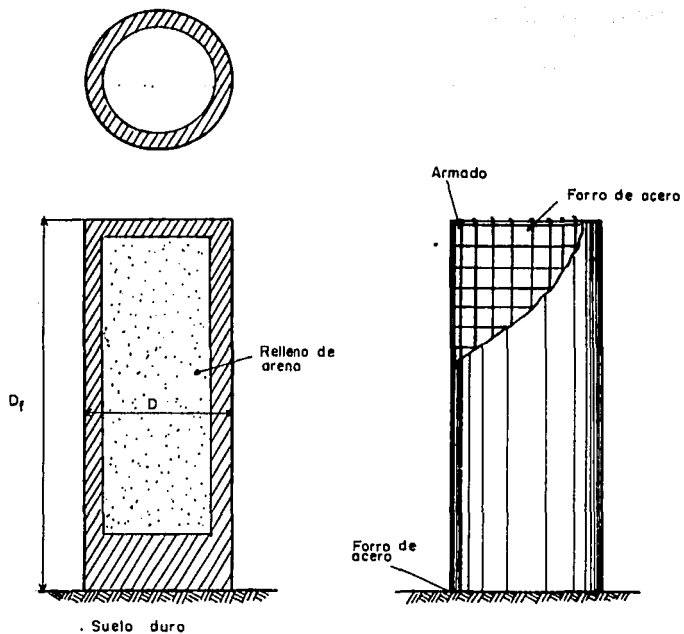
Cilindro de cimentación. a) Corte del cilindro, b) Armado de un cilindro.
